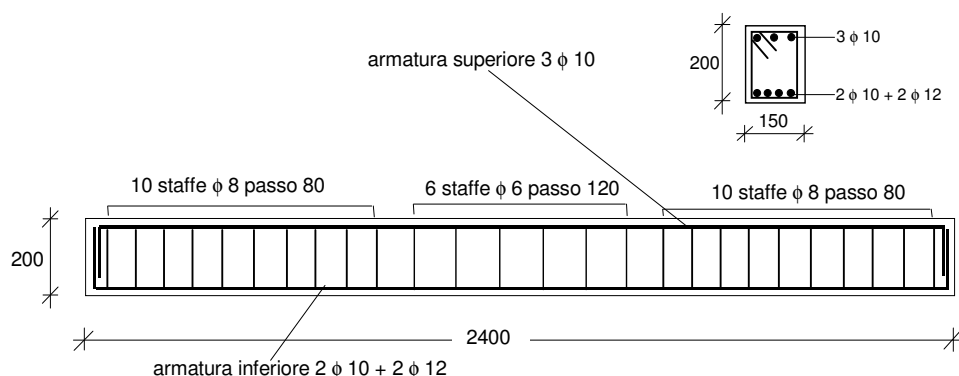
Dimensioni e armature metalliche delle travi oggetto della sperimentazione (misure in mm)
